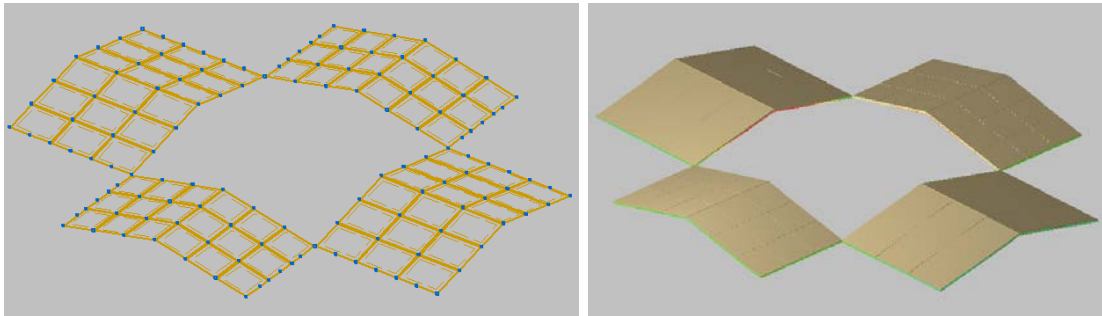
Losa de hormigón armado, HA-25, con 150 mm de espesor.
